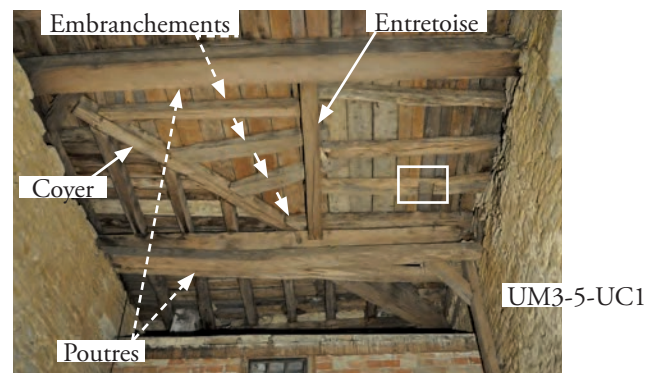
Disposition du plafond-plancher au niveau de la cheminée (UM3-5-UC2)
